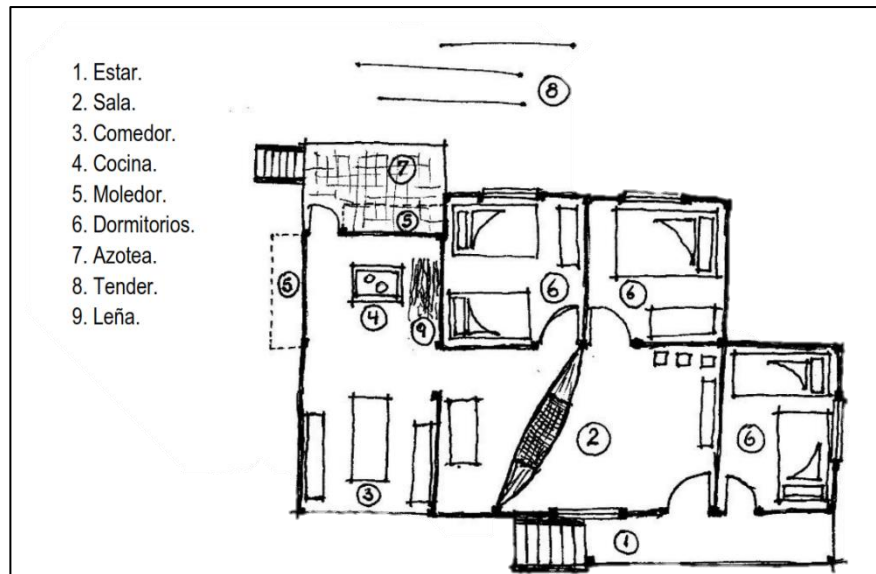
Planta arquitectónica de vivienda manabita elevada entre 1.20 m y 1.80 m sobre el suelo Fuente: (Cevallos, 2020)
